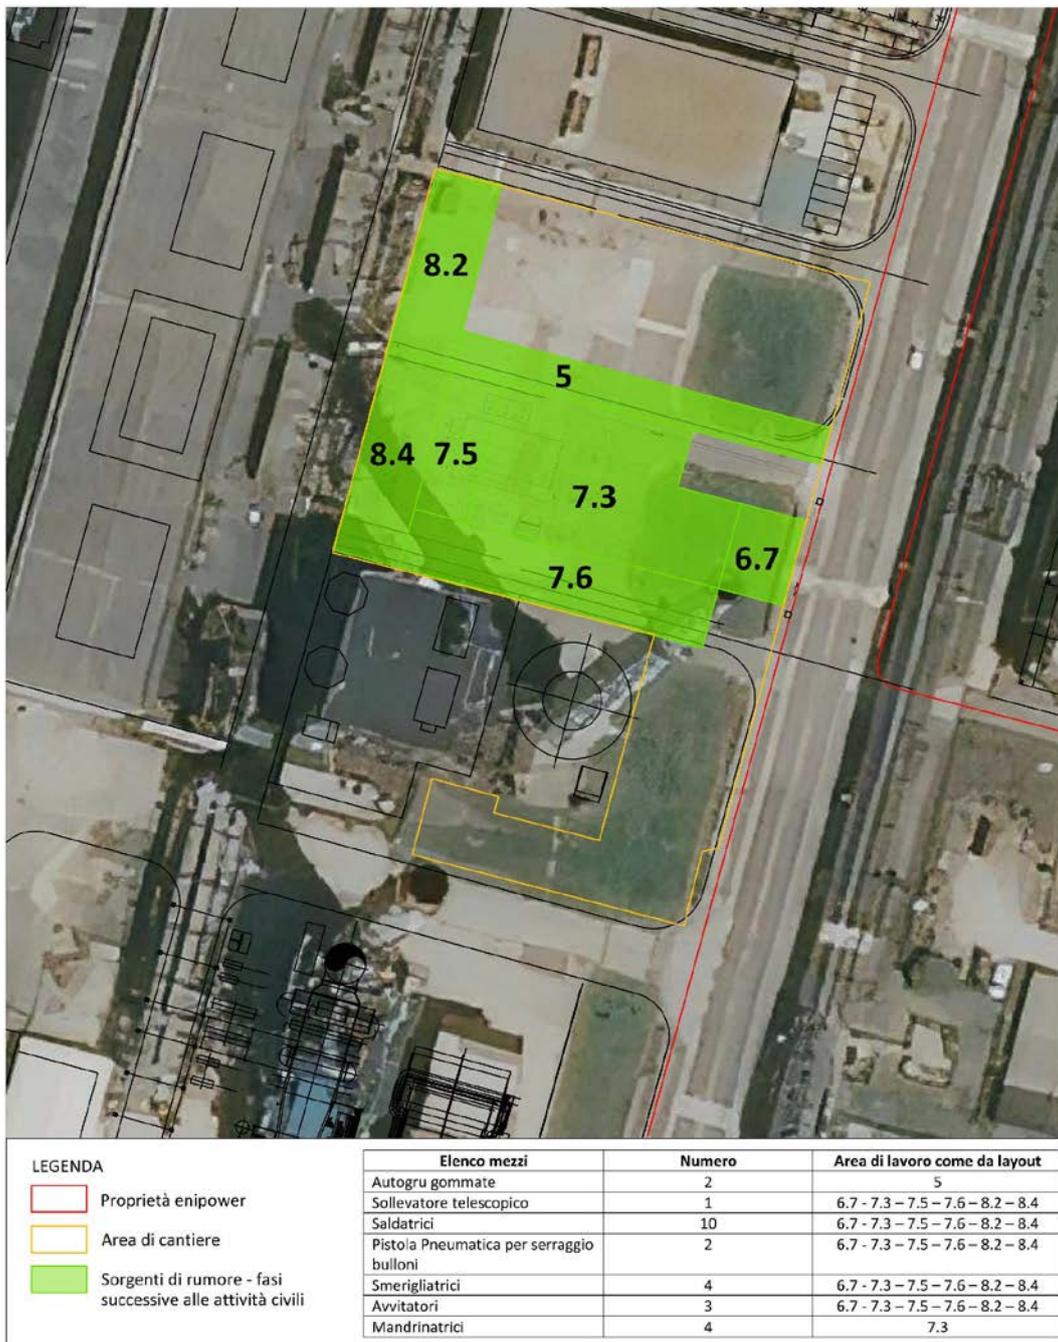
Layout di cantiere con indicazione delle aree di lavoro e relativi mezzi- Fasi successive alle opere civili
